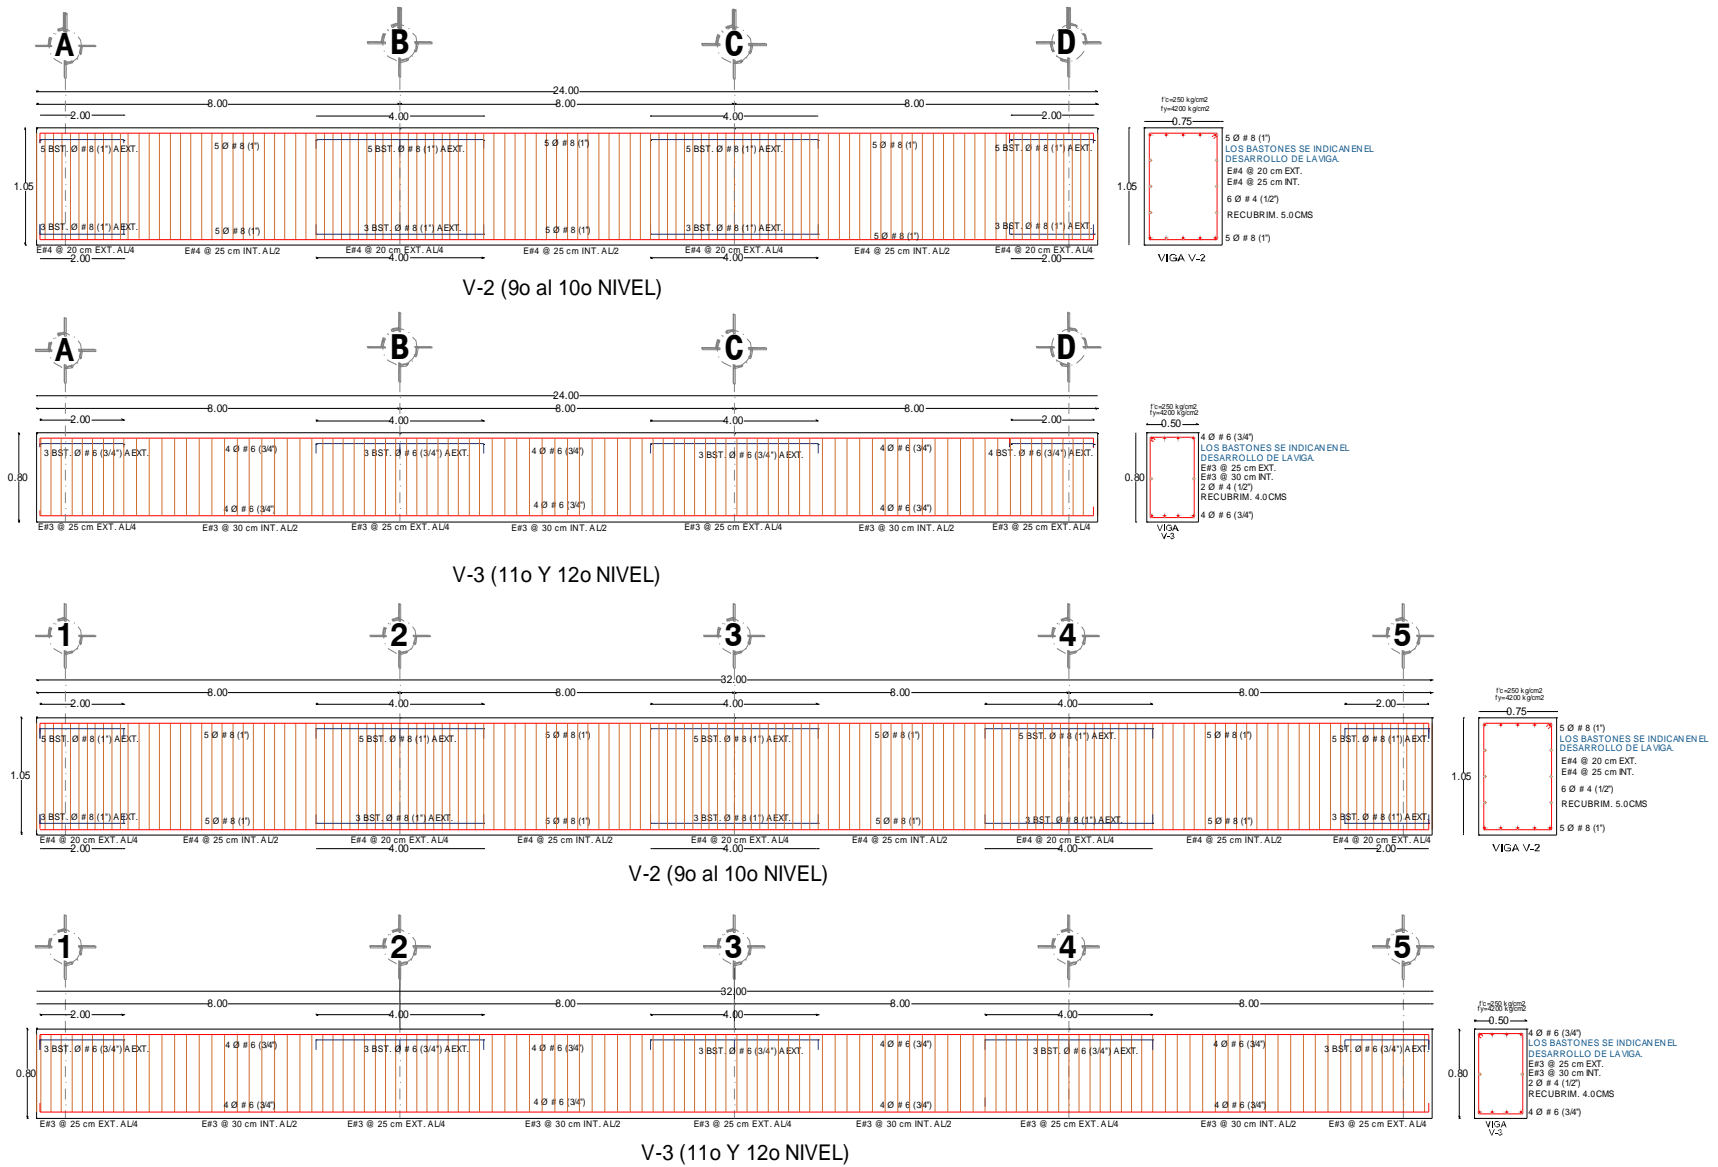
Detallado de armado de vigas de edificio de 12 niveles con base a la hipótesis de las NTCC-17.
